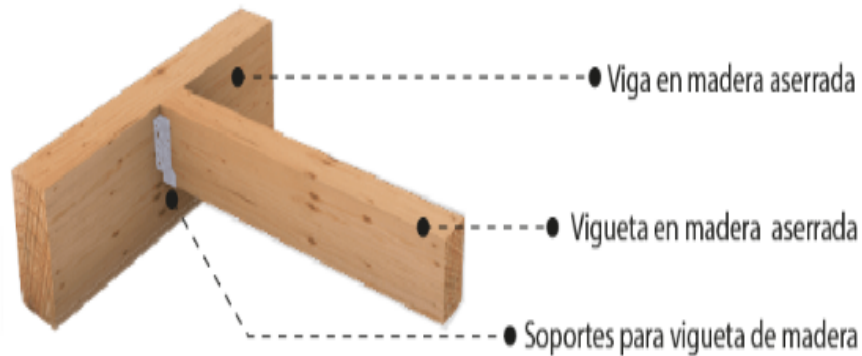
Detalle de unión de viga y vigueta. Elaboración Propia.
